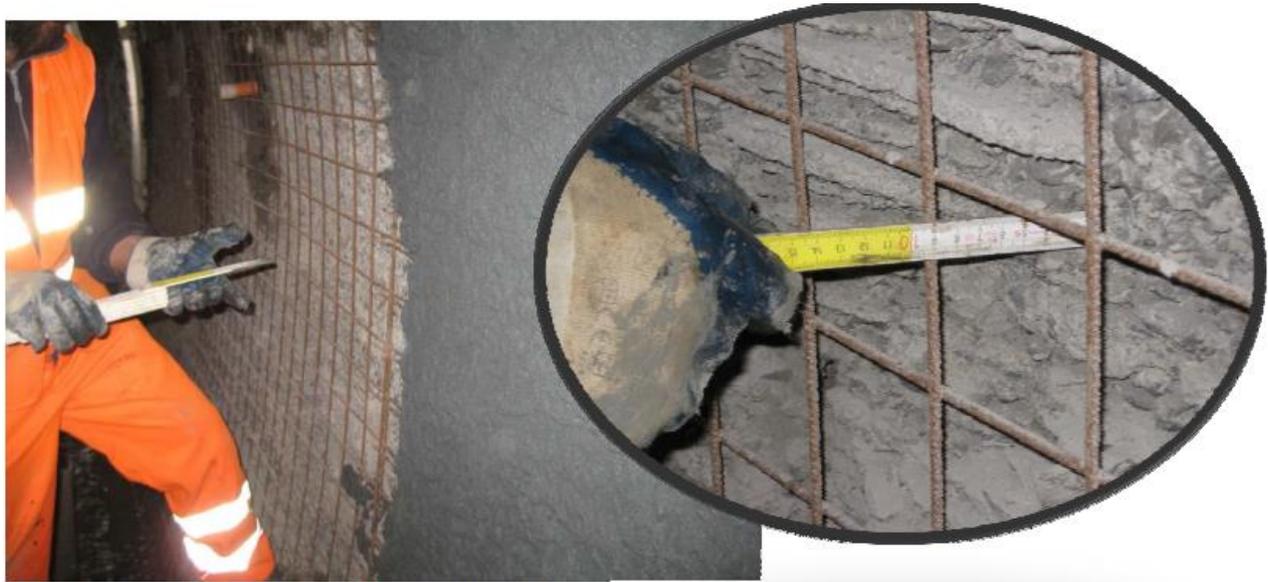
La rete è distanziata dal supporto, ma la ruvidità per un corretto aggrappo non è sufficiente, mancano perni di collegamento.
